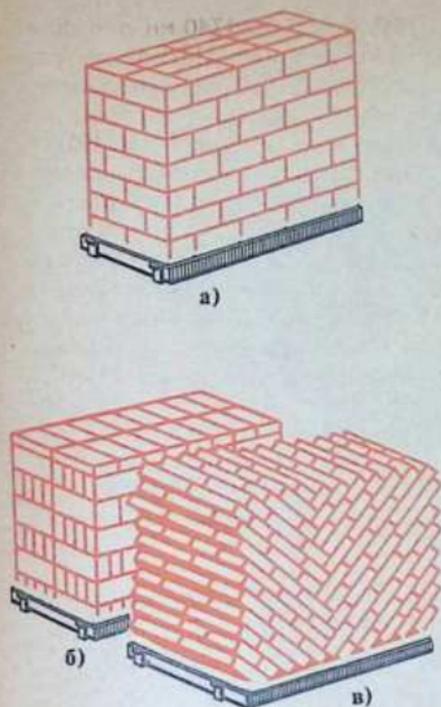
Схемы укладки кирпича на поддонах: а, б — с перекрестной перевязкой, в — с перевязкой «в елку»
